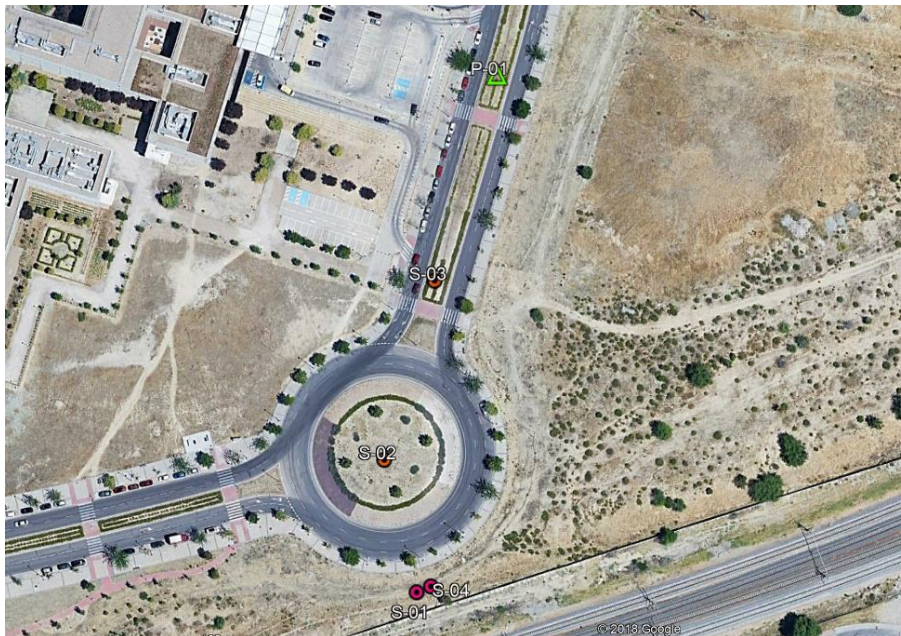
Planta de ubicación de las prospecciones realizadas.
